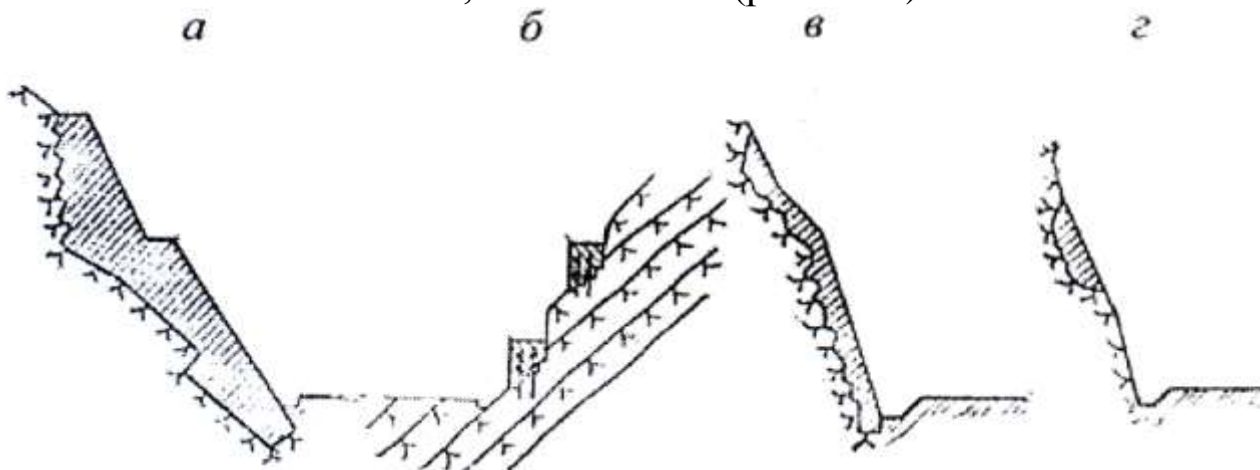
Схема подпорных стенок и облицовочных стен: *а* – опора, врезанная в тело грунтового массива; *б* – опояски; *в* – облицовочная стена; *г* – шпонка
